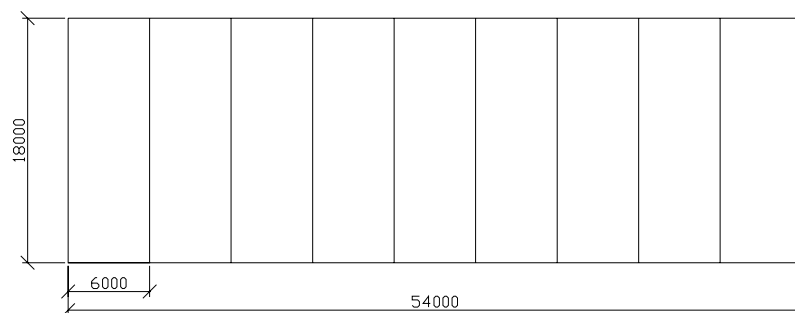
Схема розміщення рам в плані по рис.8.12
